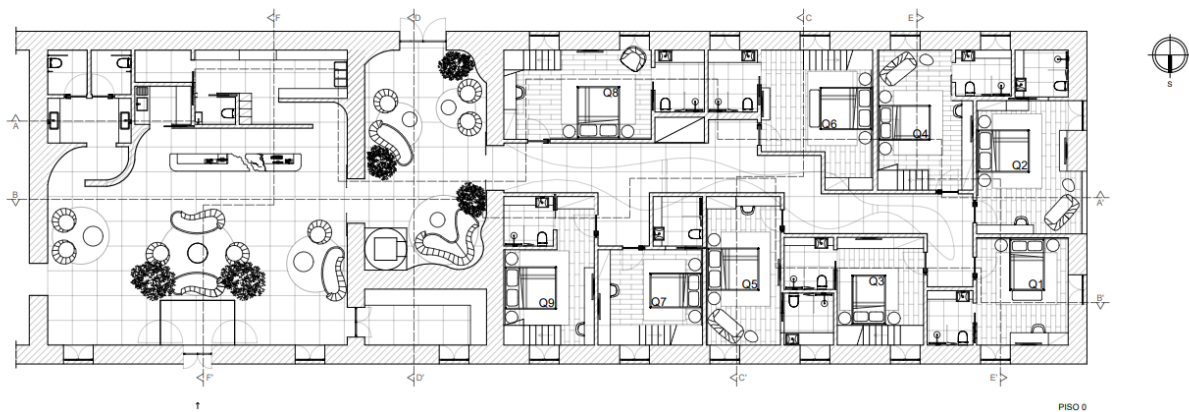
Planta de Apresentação, Piso 0, Alojamento Olive
